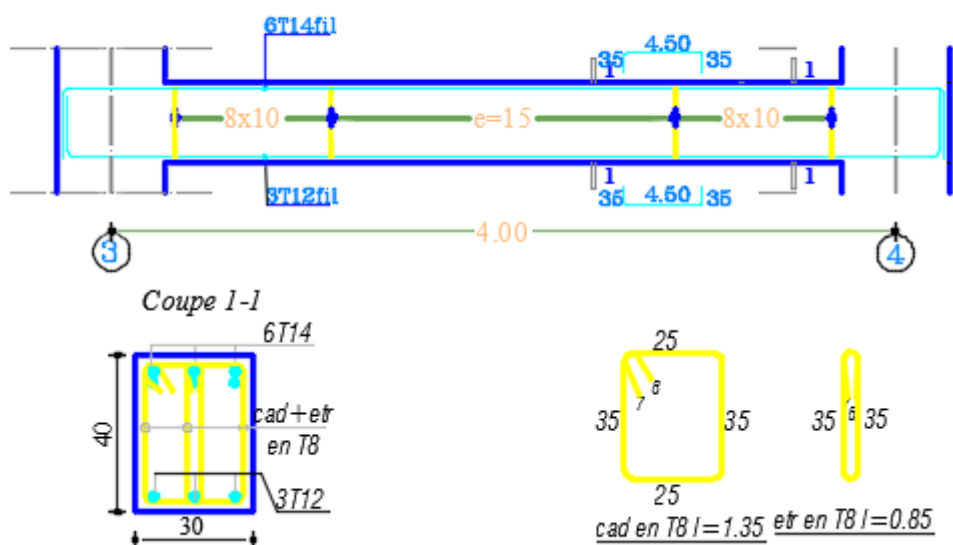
Schémas de ferrailage de la poutre palière.
